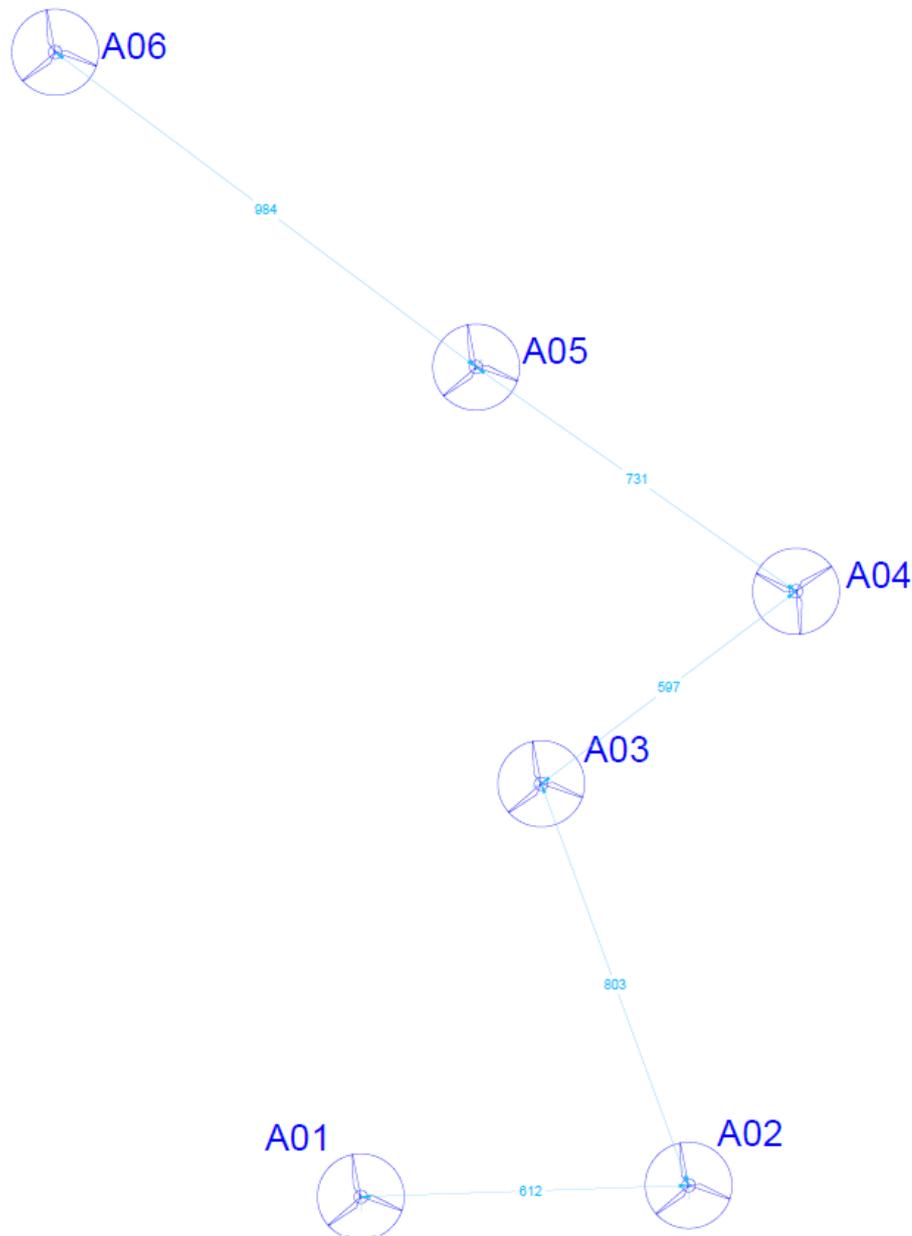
Schema layout con indicazione delle interdistanze tra le turbine di progetto.
